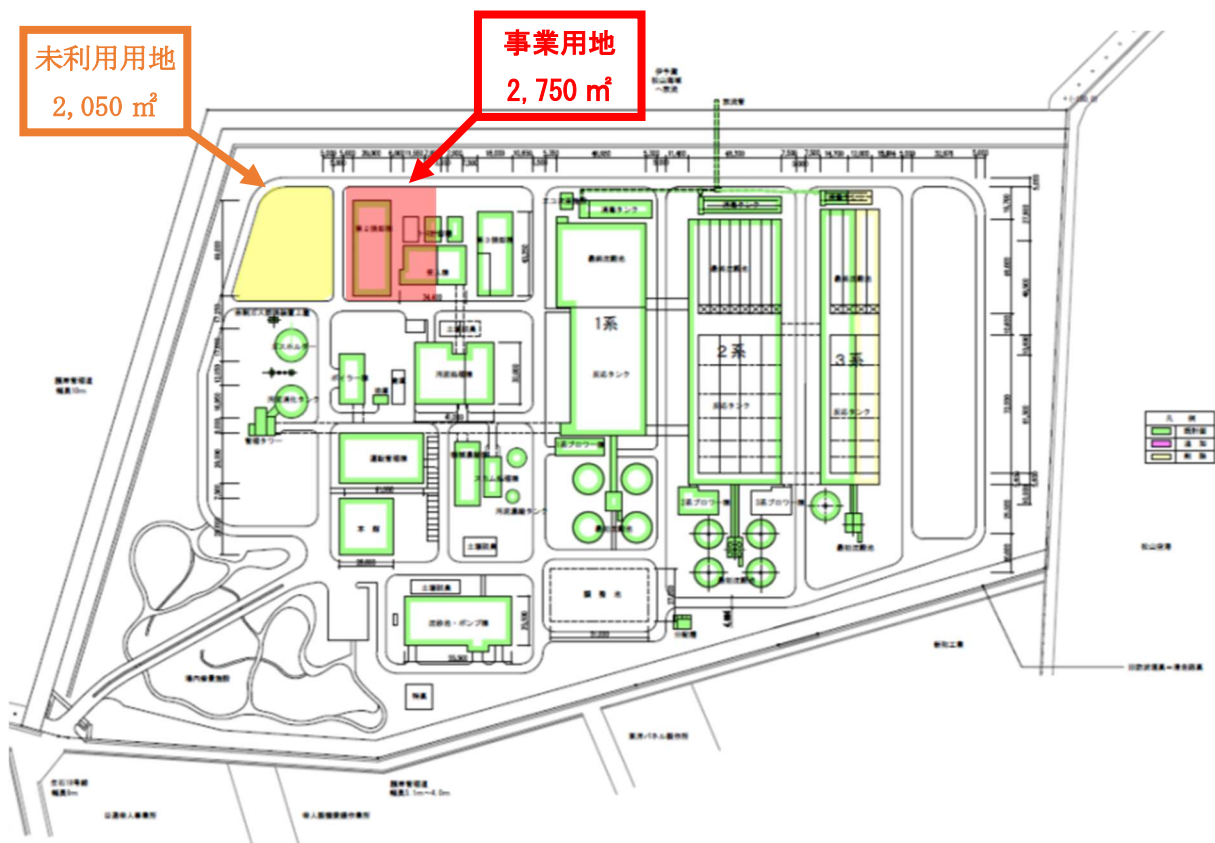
西部浄化センターの一般平面図及び事業用地等位置図
